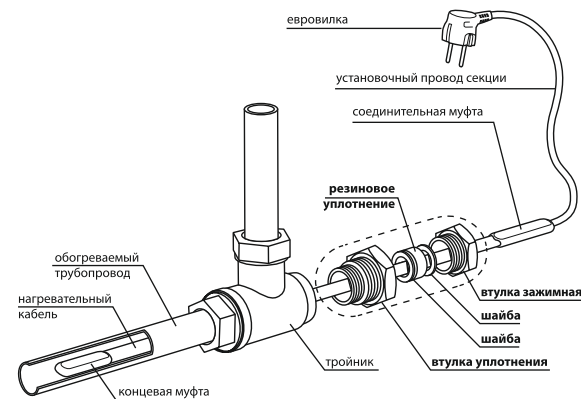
Пример монтажа (сборки) сальникового узла на нагревательный кабель
